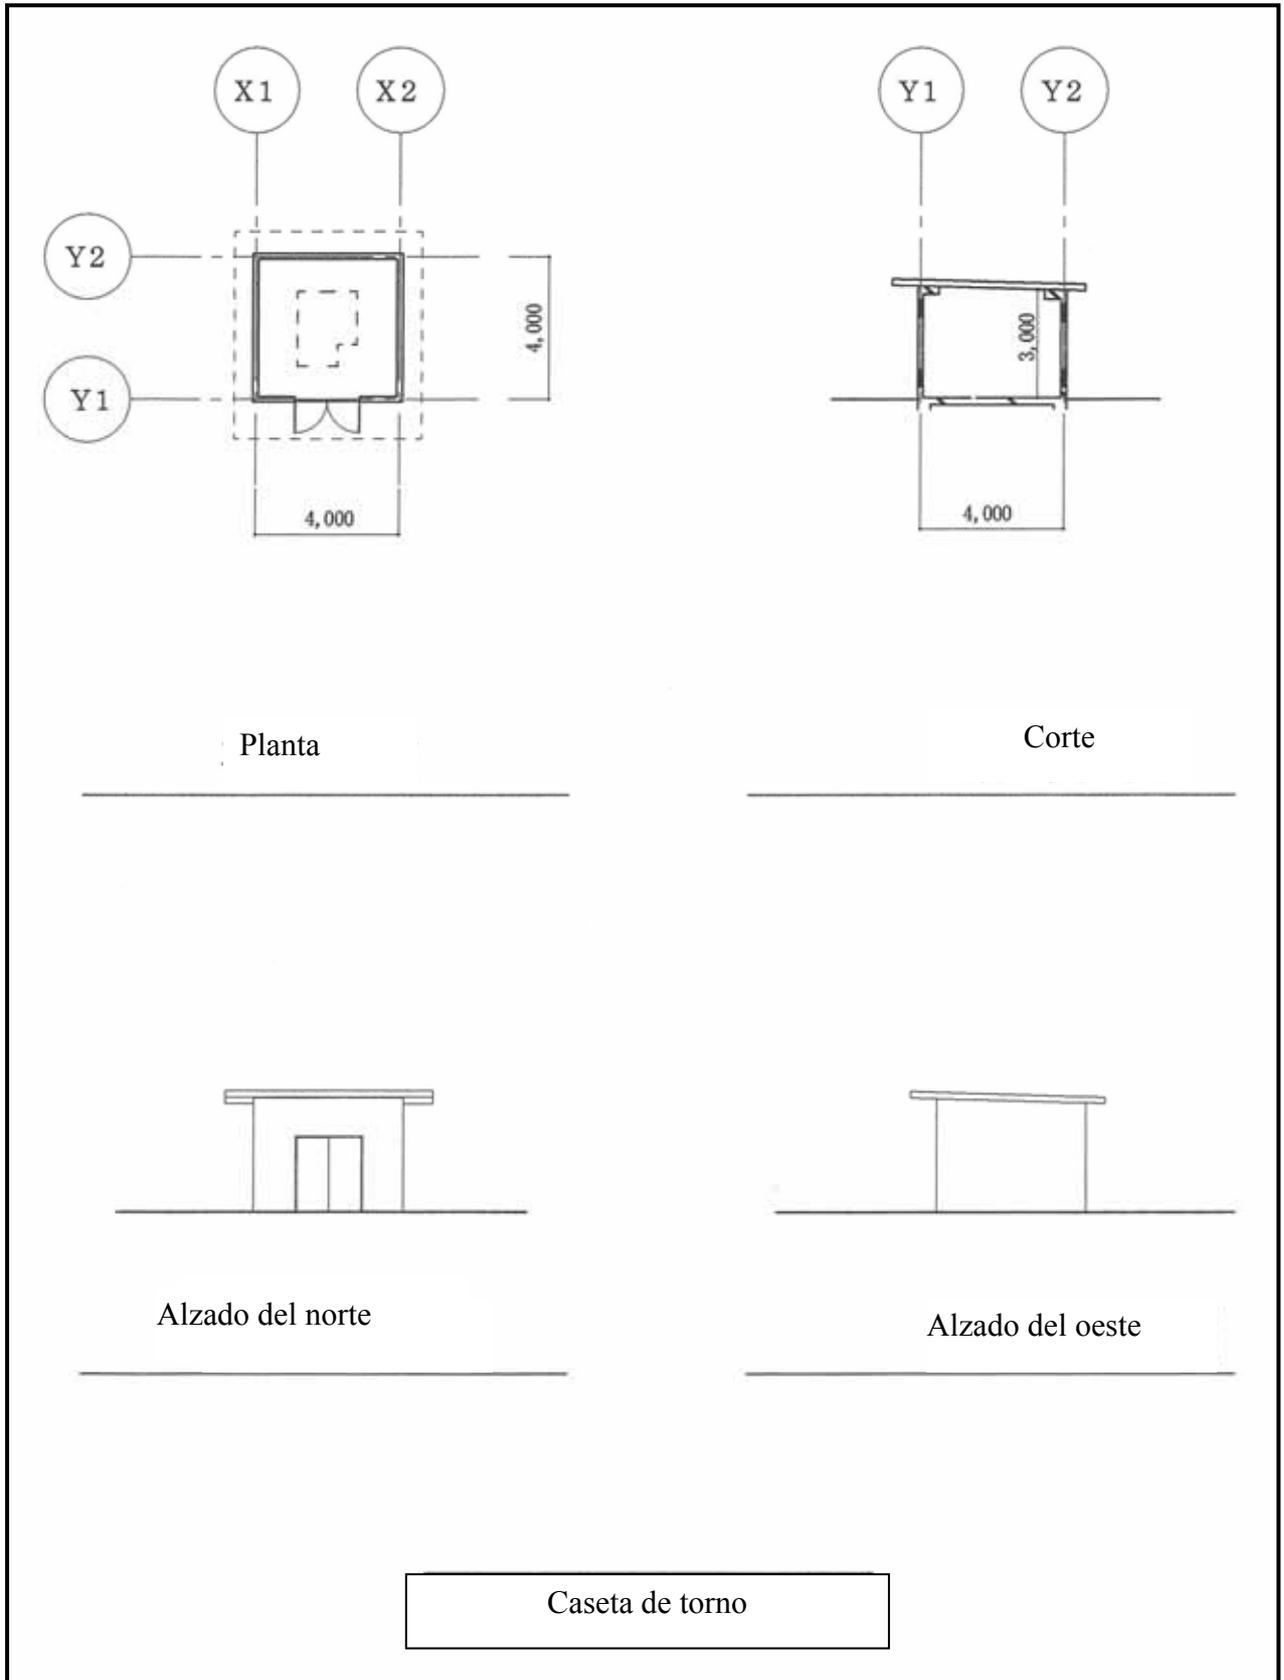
Planta, corte y alzado de la caseta de torno
